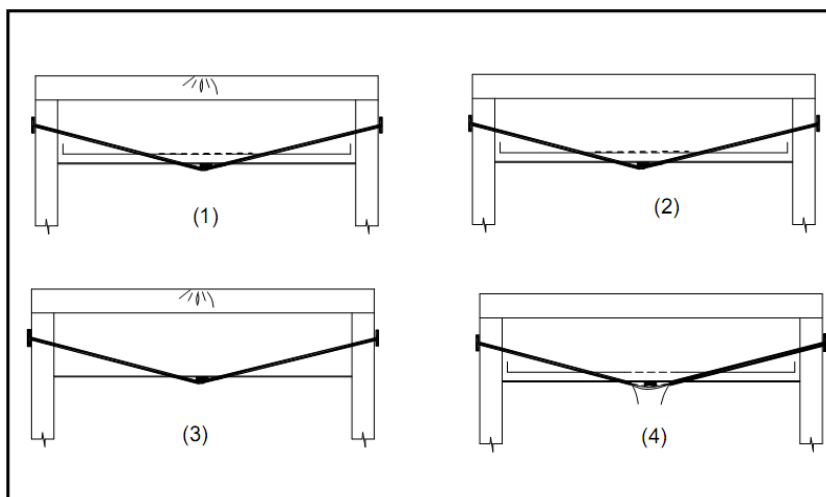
Modos de Ruína à flexão de viga de concreto armado reforçada por encamisamento, segundo Santos (2006)
